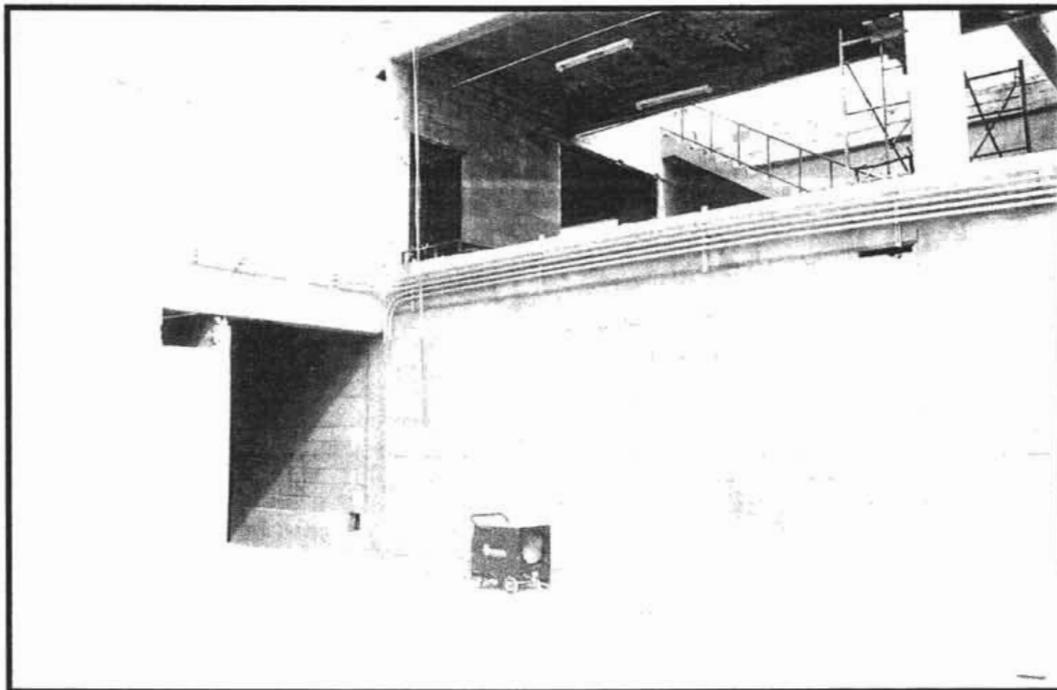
Figura II.II Muros de separación contrafuego para confinamiento de un posible incendio
